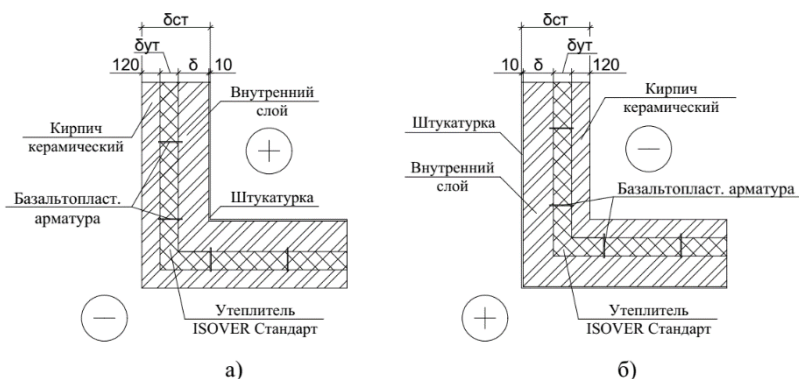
Узлы ограждающей конструкции: а) узел внутреннего угла здания; б) узел наружного угла здания
